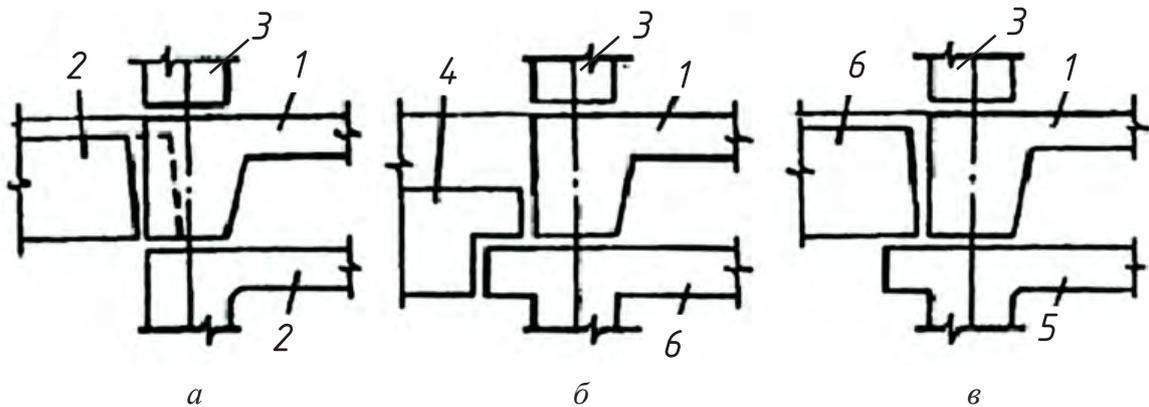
Горизонтальные стыки панельно-блочных зданий с опиранием плиты перекрытия: *а* — с помощью опорных «пальцев» плит перекрытия; *б, в* — на консольный выступ сверху объемного блока: 1 — плита пола объемного блока; 2 — плита перекрытия с опорными «пальцами»; 3 — потолочная плита объемного блока; 4 — плита перекрытия с подрезкой на опоре; 5 — потолочная плита объемного блока с консолью для опирания плиты перекрытия; 6 — укороченная плита перекрытия
